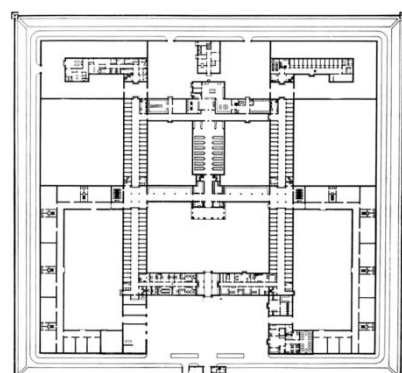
38 – 39 | CADEIA CENTRAL DO NORTE (PAÇOS DE FERREIRA) | GALERIA DE ACESSO ÀS CELAS | PLANTA PISO TÉRREO DA CADEIA CENTRAL DO NORTE (1957)
